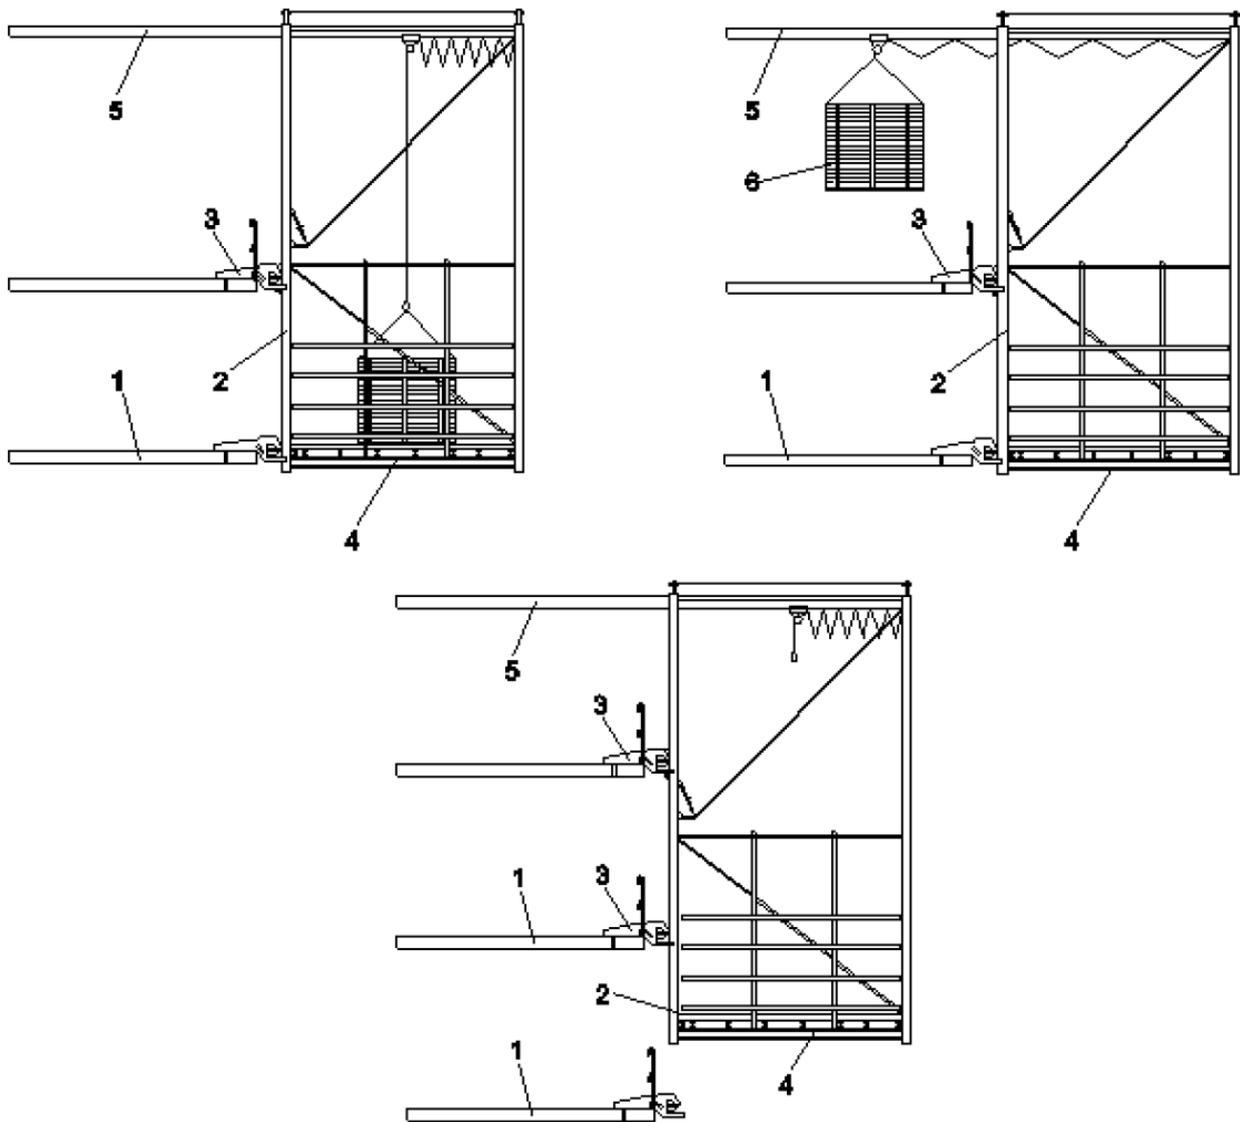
Схема перемещения опалубки по высоте с применением кран-балки
